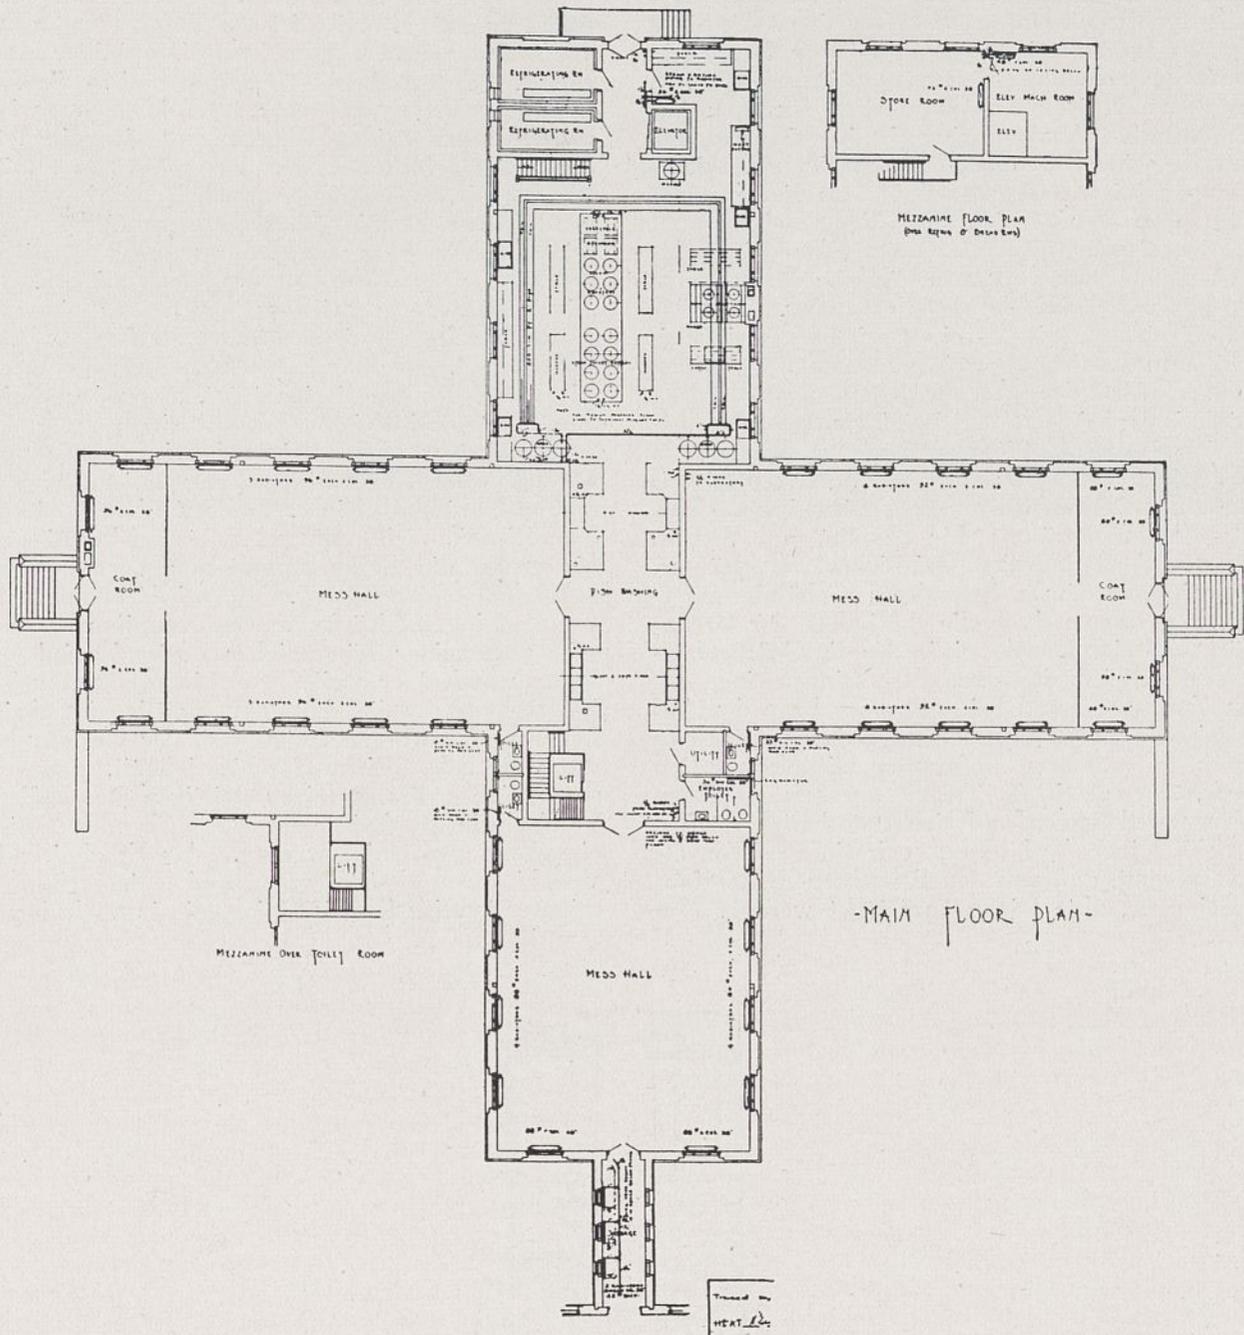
New Sing Sing Prison, N. Y. Speisehallen und Küchengebäude, Grundriß des Hauptgeschosses. Architekt: E. F. Pilcher.
